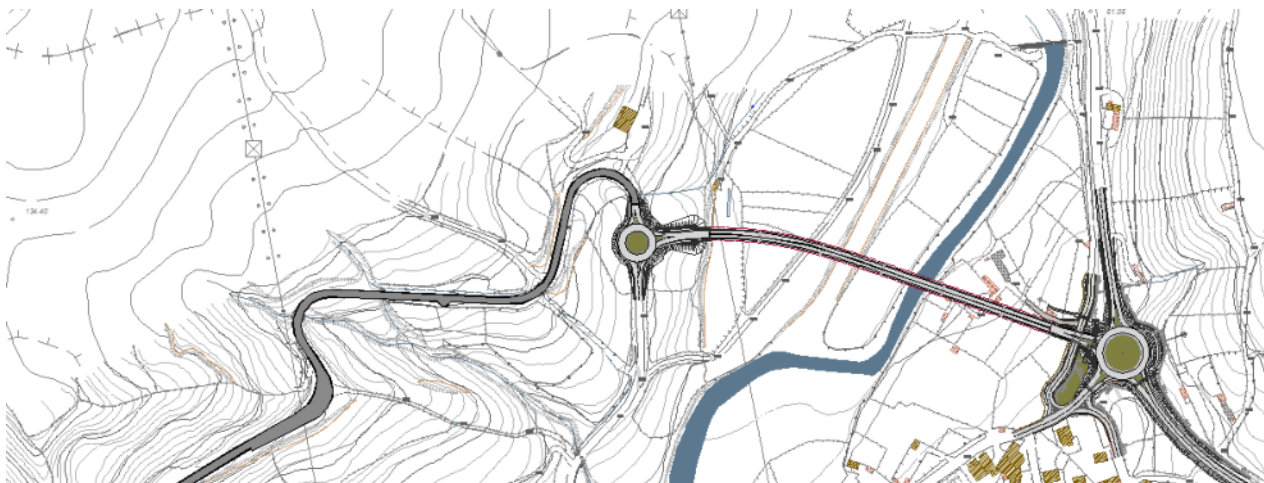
Stralcio Planimetrico della soluzione A1/A2
